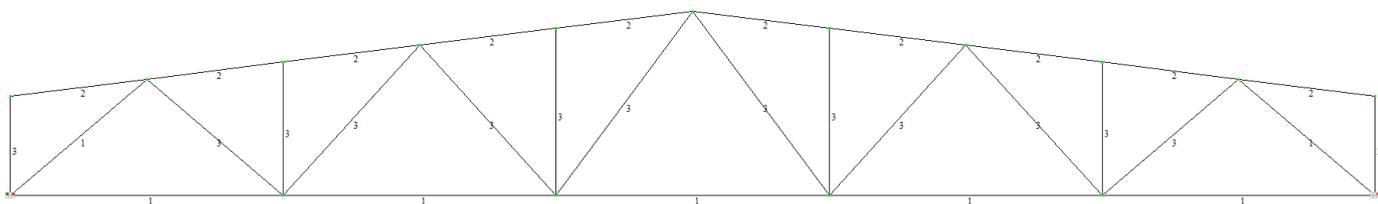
Расчетная схема фермы с назначенными жесткостями
